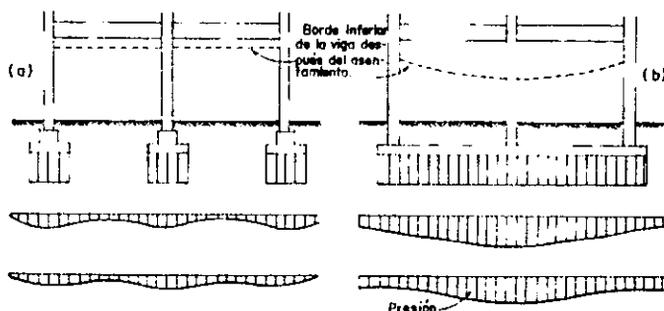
Distribución de las presiones dentro del suelo situado debajo de un edificio: (a) apoyado sobre zapatas muy espaciadas entre sí; (b) apoyado sobre una losa de concreto. La presión unitaria que se transmite al suelo es la misma en ambos casos.
